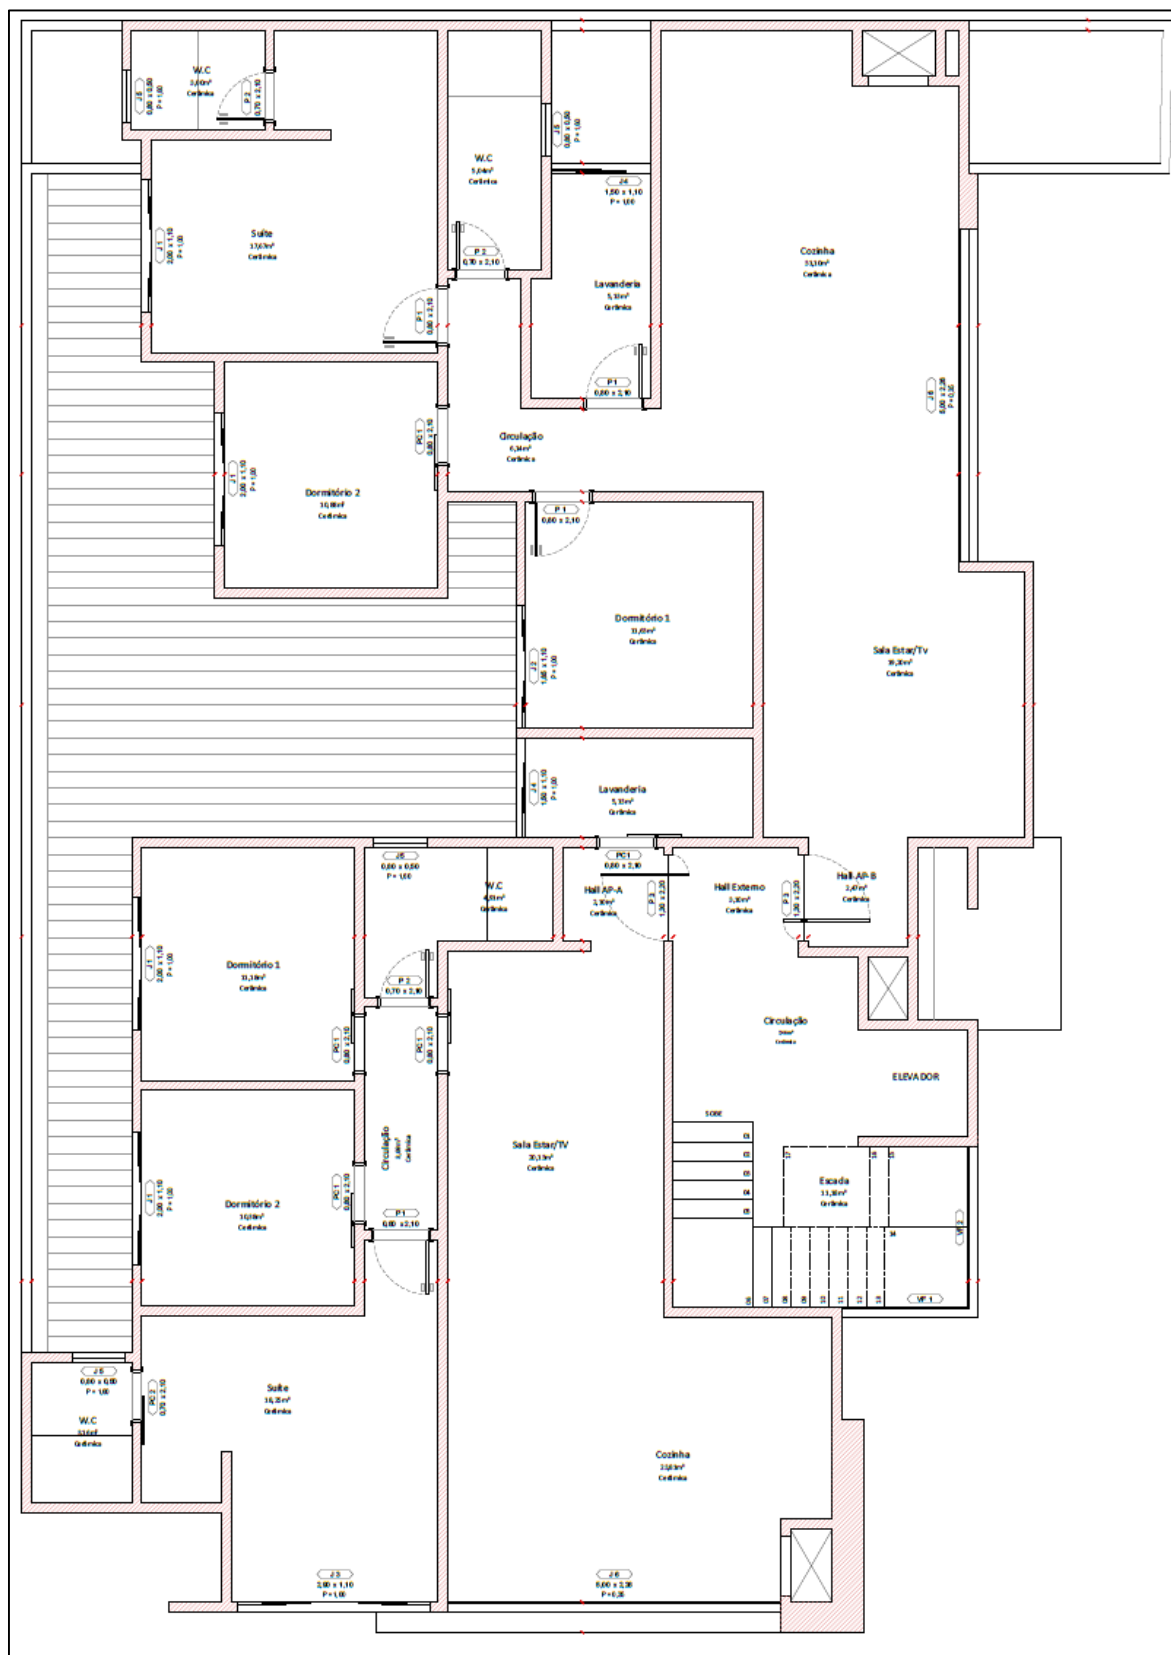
Projeto Arquitetônico do Pavimento Tipo
